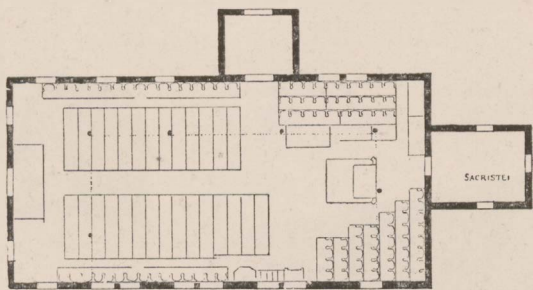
Grundriß der evangelischen Kirche in Stalle.
